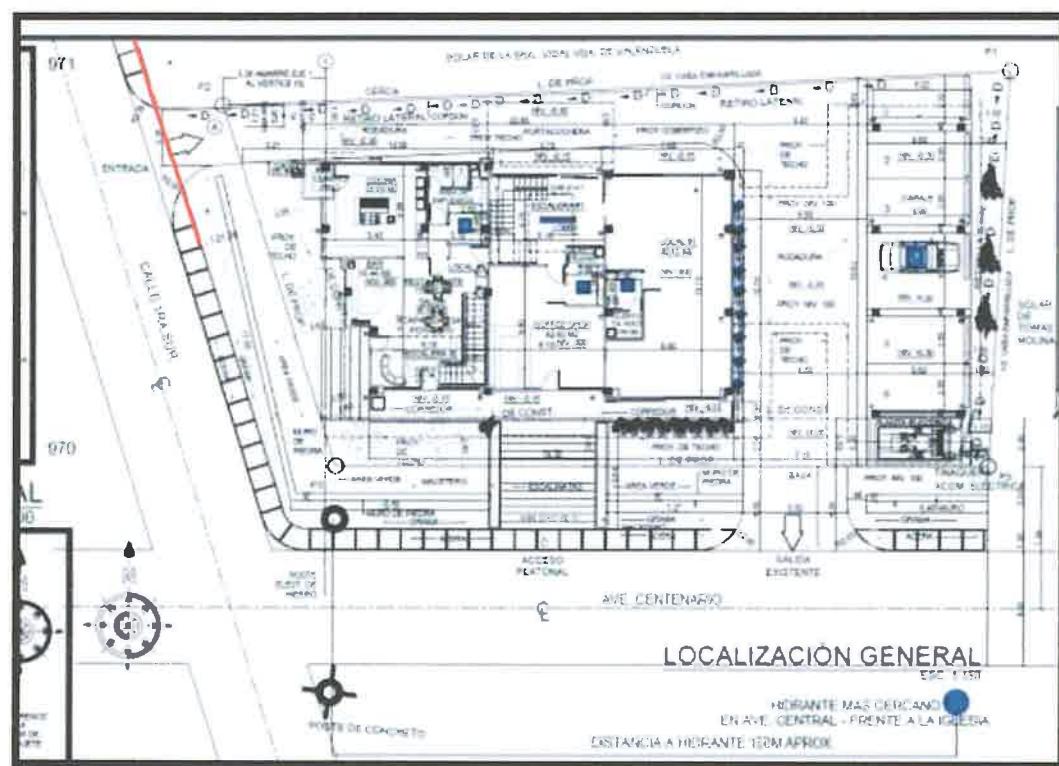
Acceso al proyecto por calle 1RA Sur, donde se realizará actividad de corte.
